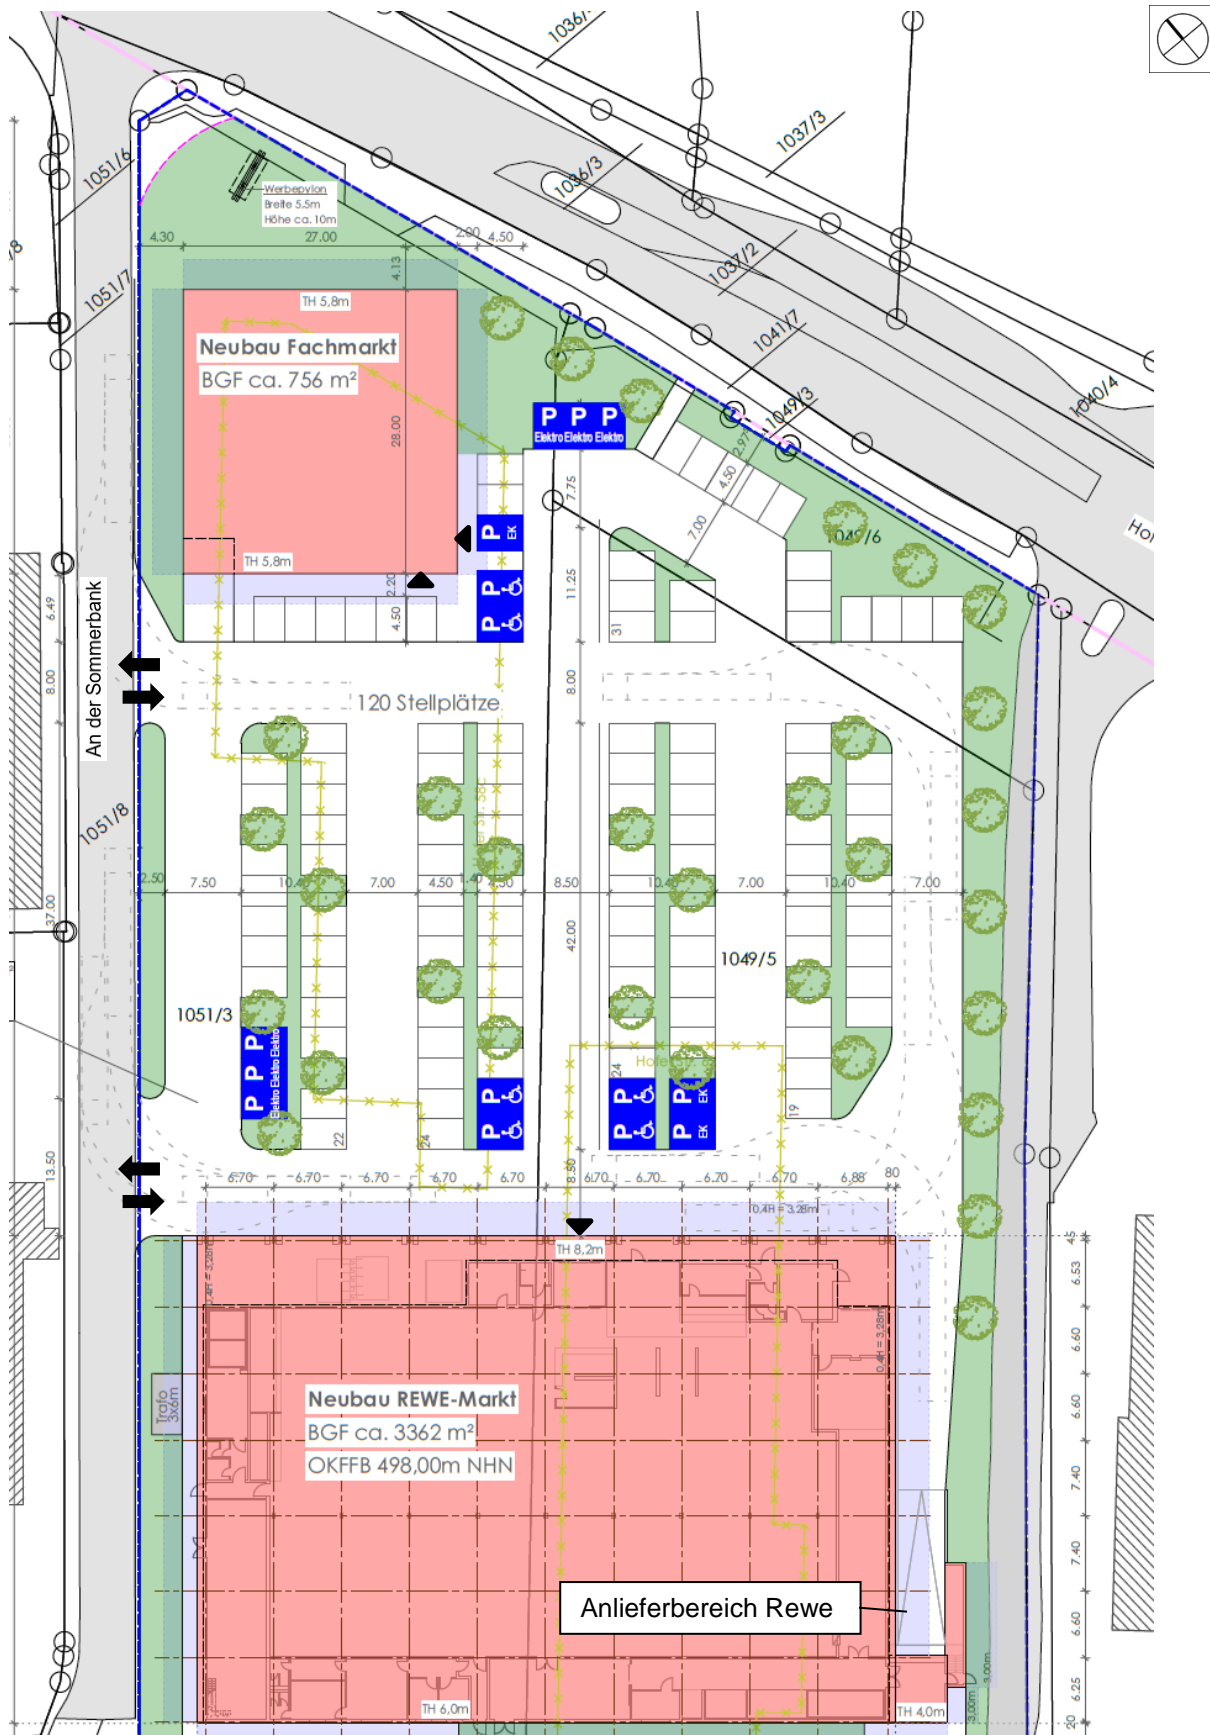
Auszug aus dem Lageplan zur Objektplanung,
